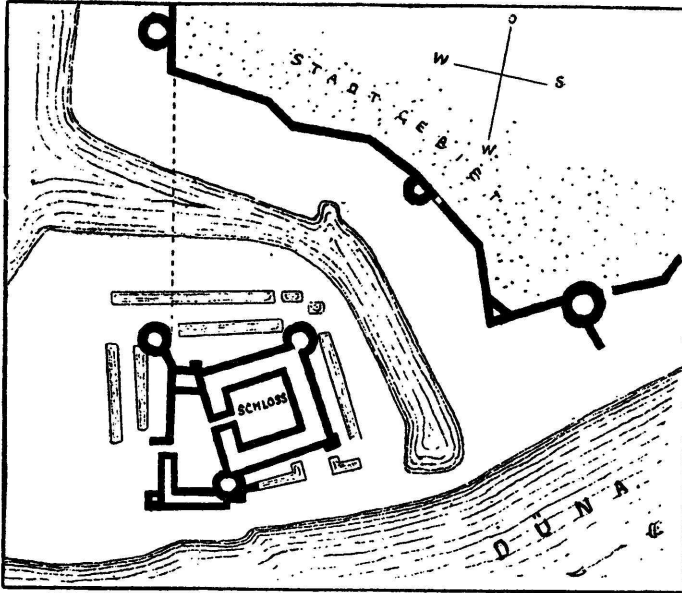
Grundriss der Burg aus dem Jahre 1646. Nach Neumann.
